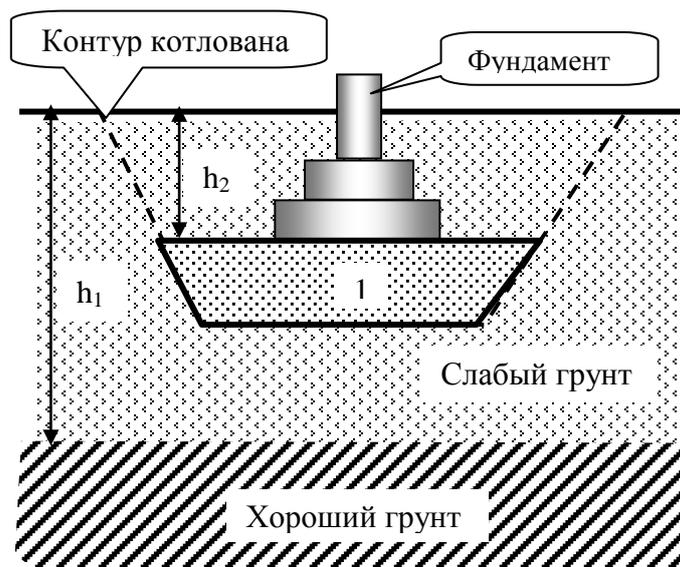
Песчаная подушка не полностью прорезает слабый слой грунта
